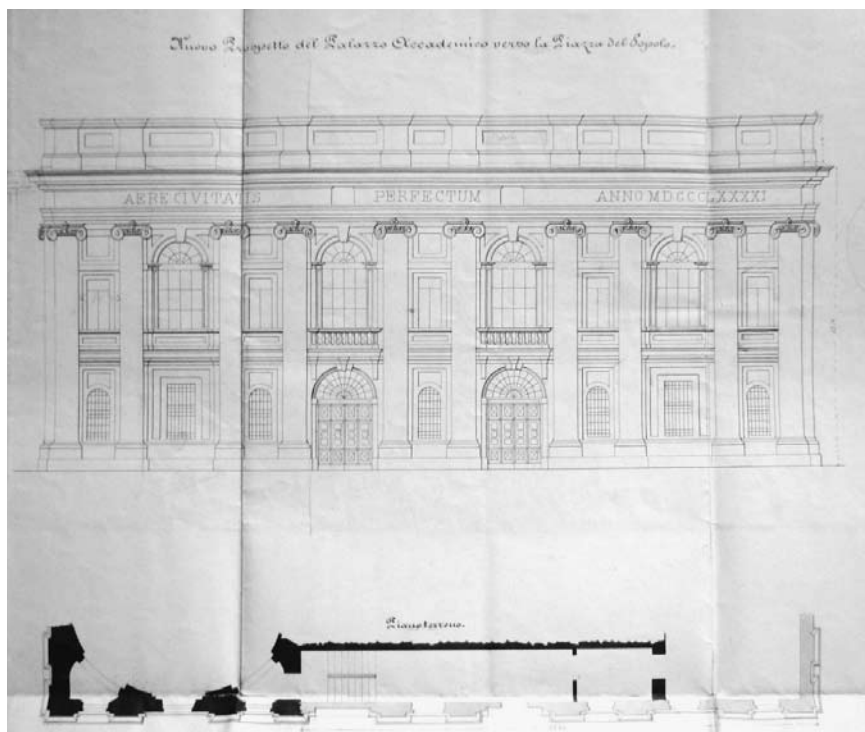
Carlo Andreani. Progetto per la nuova facciata su piazza Dante Alighieri del Palazzo Accademico da erigere a seguito della demolizione dell'Oratorio di Santa Maria del Popolo: «Nuovo prospetto del Palazzo Accademico verso la Piazza del Popolo». Mantova, 1890 (ASCMn, VII.4.2. Autorizzazione n. 5/2013).
